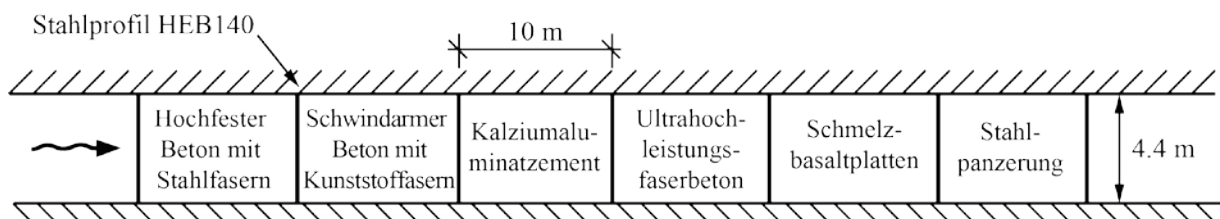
Schematische Anordnung der Testfelder im SBT Solis mit stahlfaserbewehrtem hochfestem Beton, schwindarmem Beton mit Kunststofffasern, Kalziumaluminatzementbeton, Ultrahochleistungsfaserbeton, Schmelzbasaltplasterung und Stahlpanzerung
